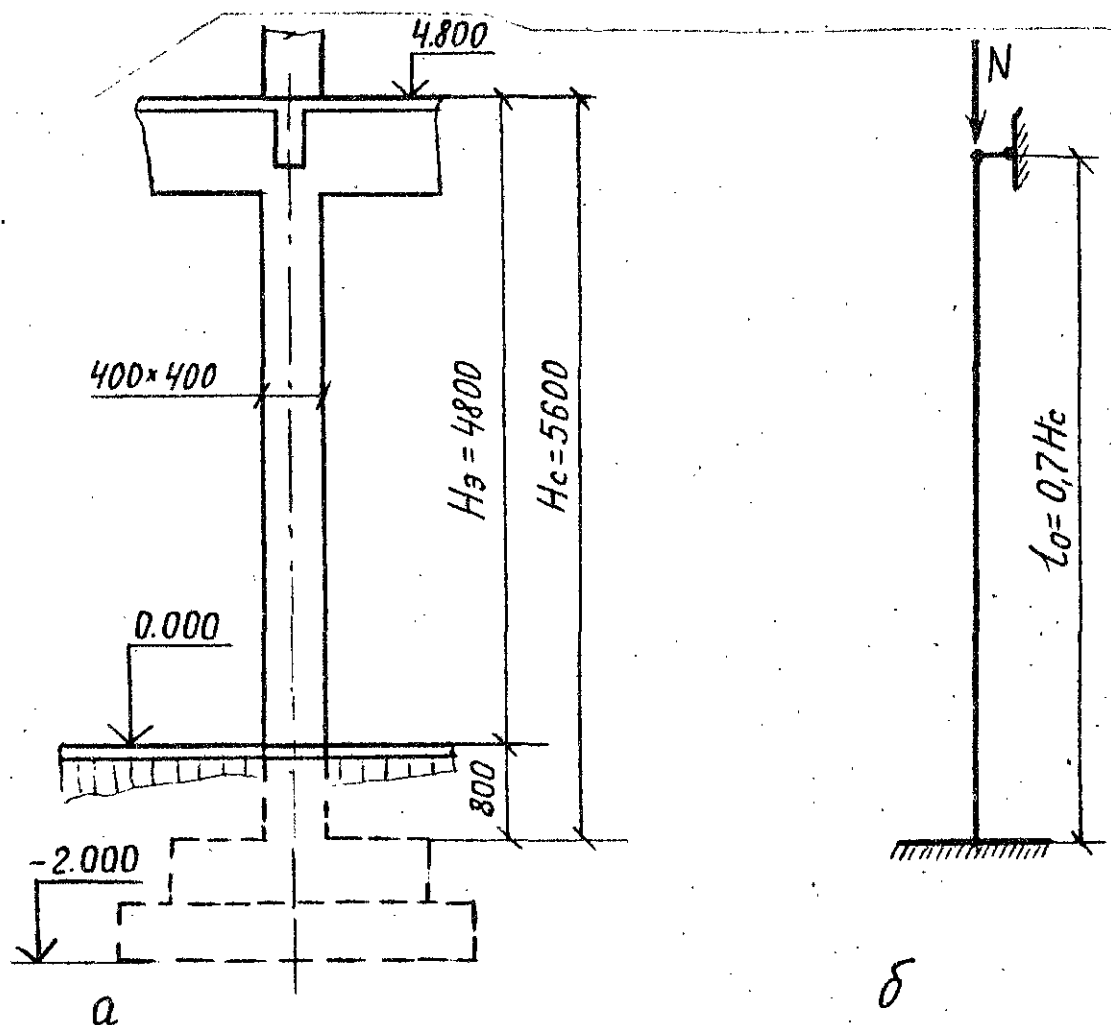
К расчету колонны I-го этажа: а – размеры колонны; б – расчетная схема
